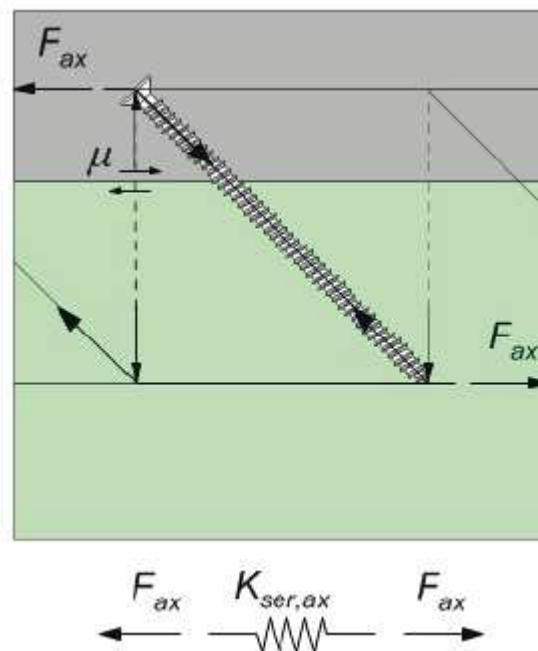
Einsinnig angeordnete zugbeanspruchte Schraube unter 45° in einer HBV-Decke [26]
